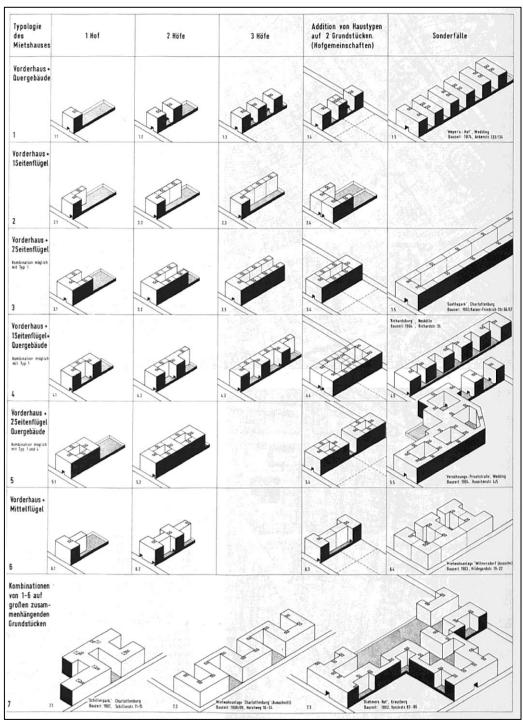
Kombination der Gebäudetypen nach Grundstücksform⁴
